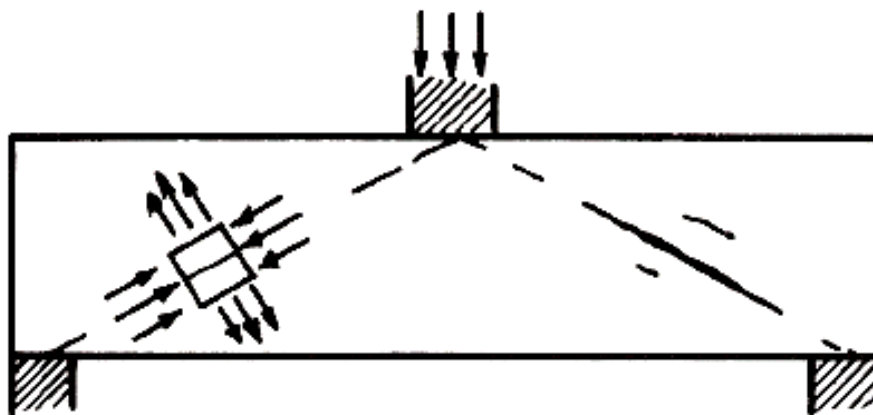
Fisuras de flexión compuesta.
